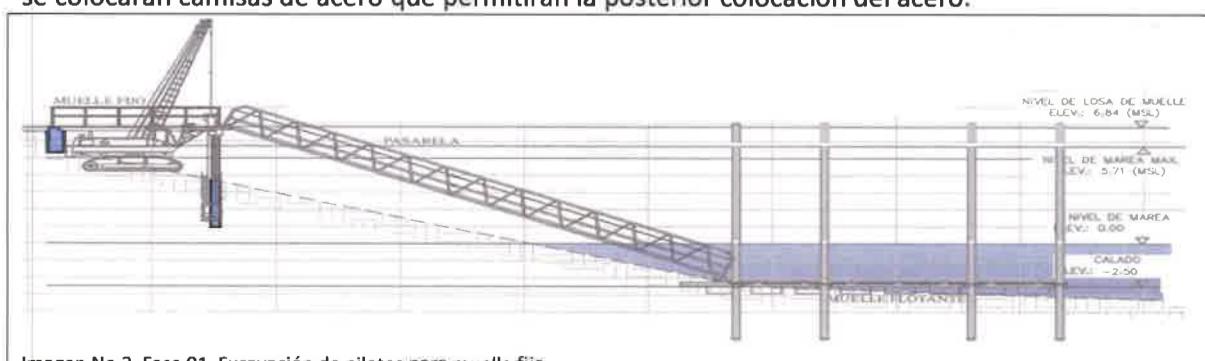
Fase 01 Excavación de pilotes para muelle fijo.
